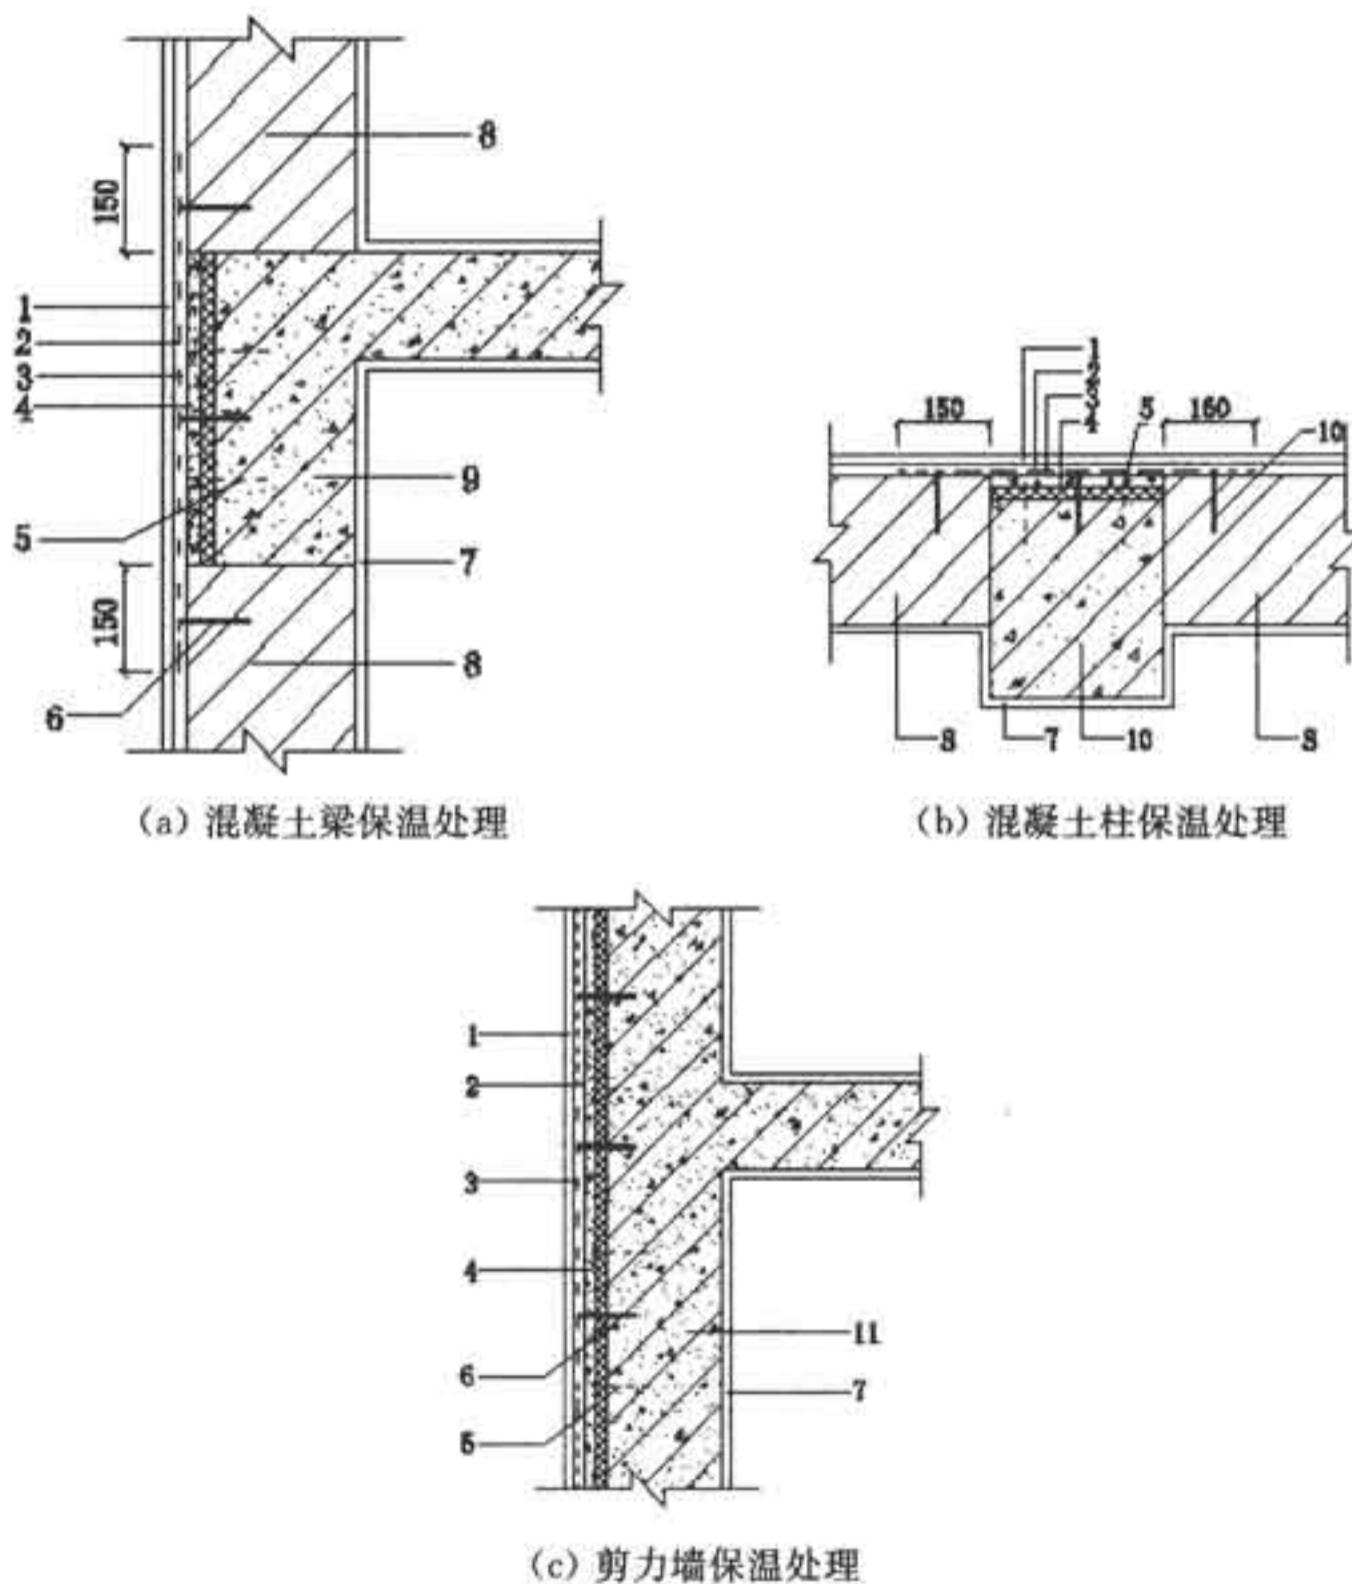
混凝土热桥、剪力墙采用复合保温板保温处理设计构造
